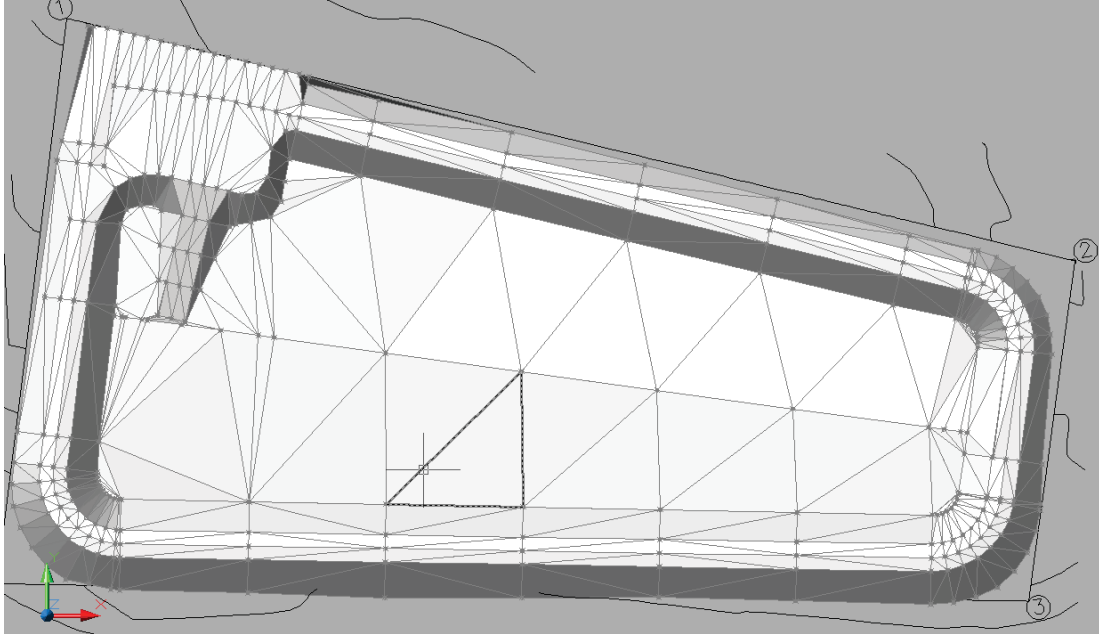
Monorrelleno de lodos visto en planta completamente trazado.
